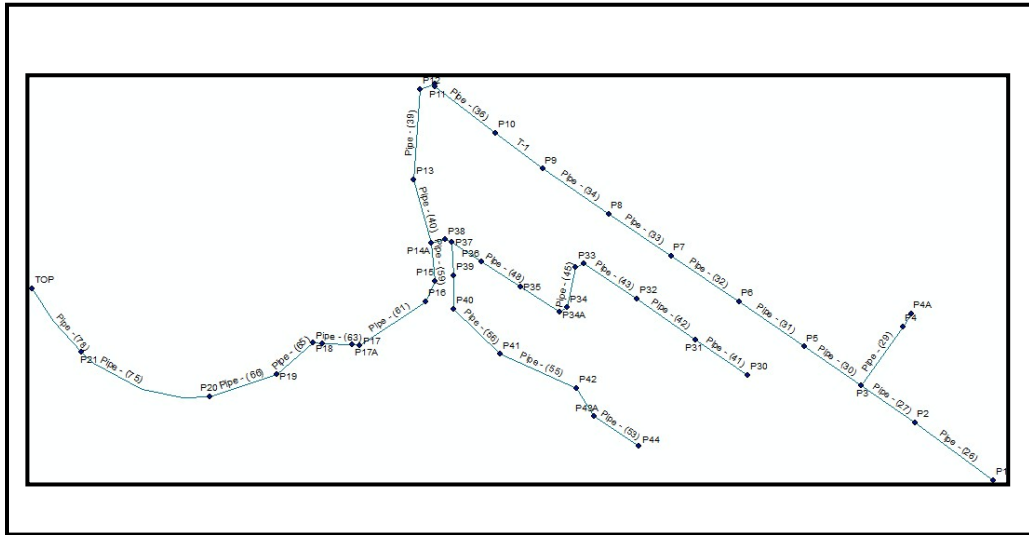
Ubicación de pozos y tuberías de la red de alcantarillado
